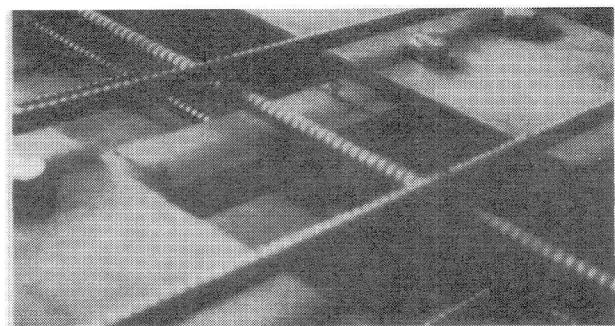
ずれ止め用山形鋼を主桁上フランジ
